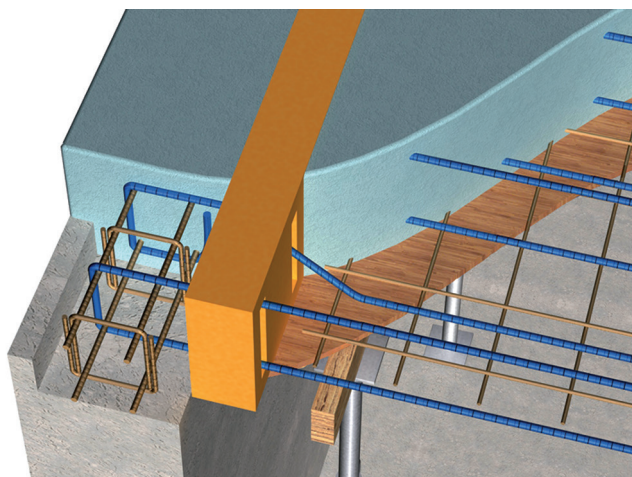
Plancher à dalle pleine coulée en œuvre, équipé d'un rupteur à appui continu.
